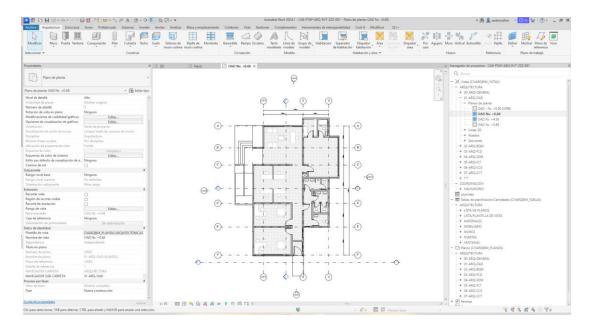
Ejemplo de visualización de planta arquitectónica módulo OAD - Revit 2024.
